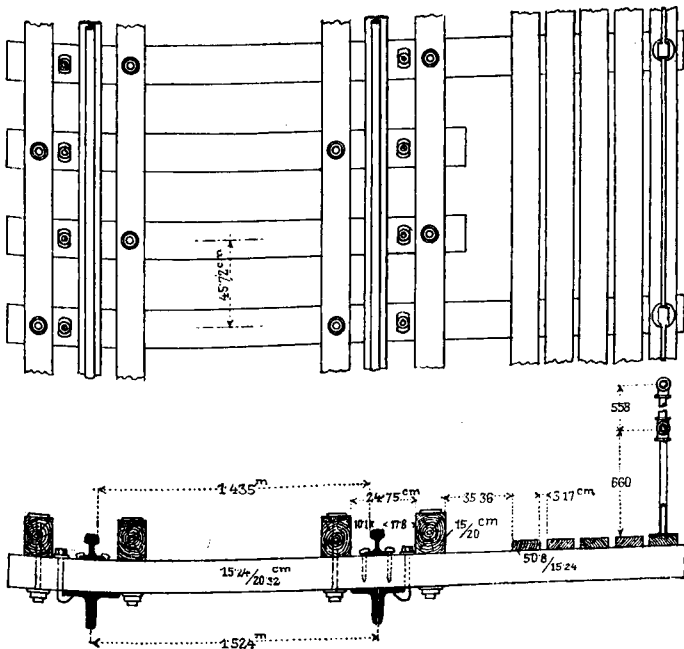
Draufsicht und Querschnitt des Oberbaues.
